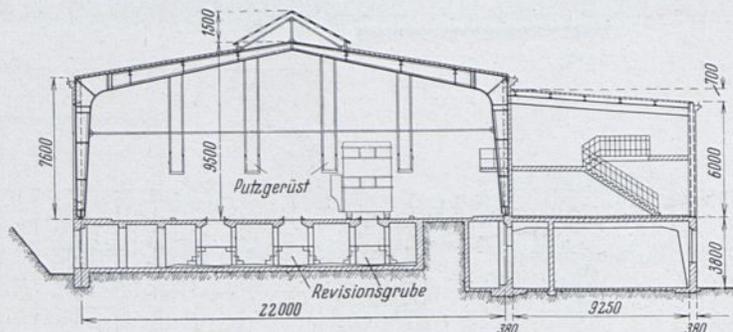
Halle I. Querschnitt an den Putzgerüsten.
